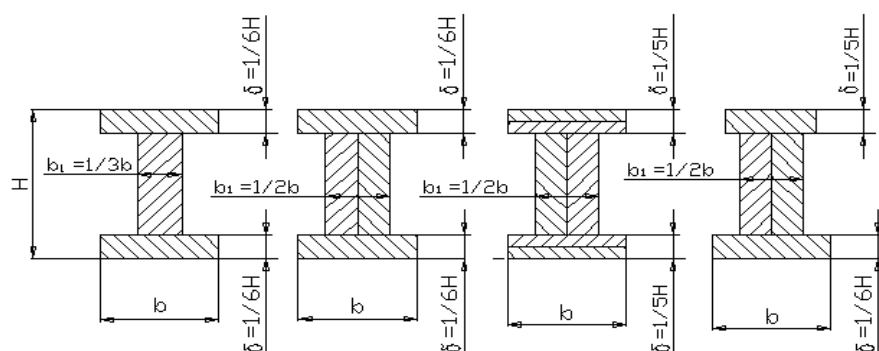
Типы поперечного сечения двутавровых клееных балок для перекрытий
